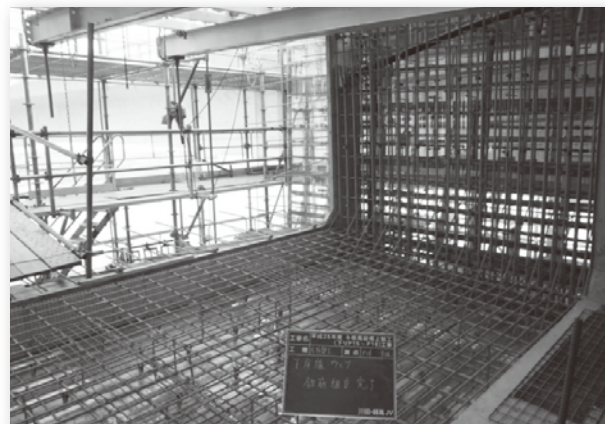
エポキシ樹脂塗装鉄筋、ポリエチレンシーす配置状況
